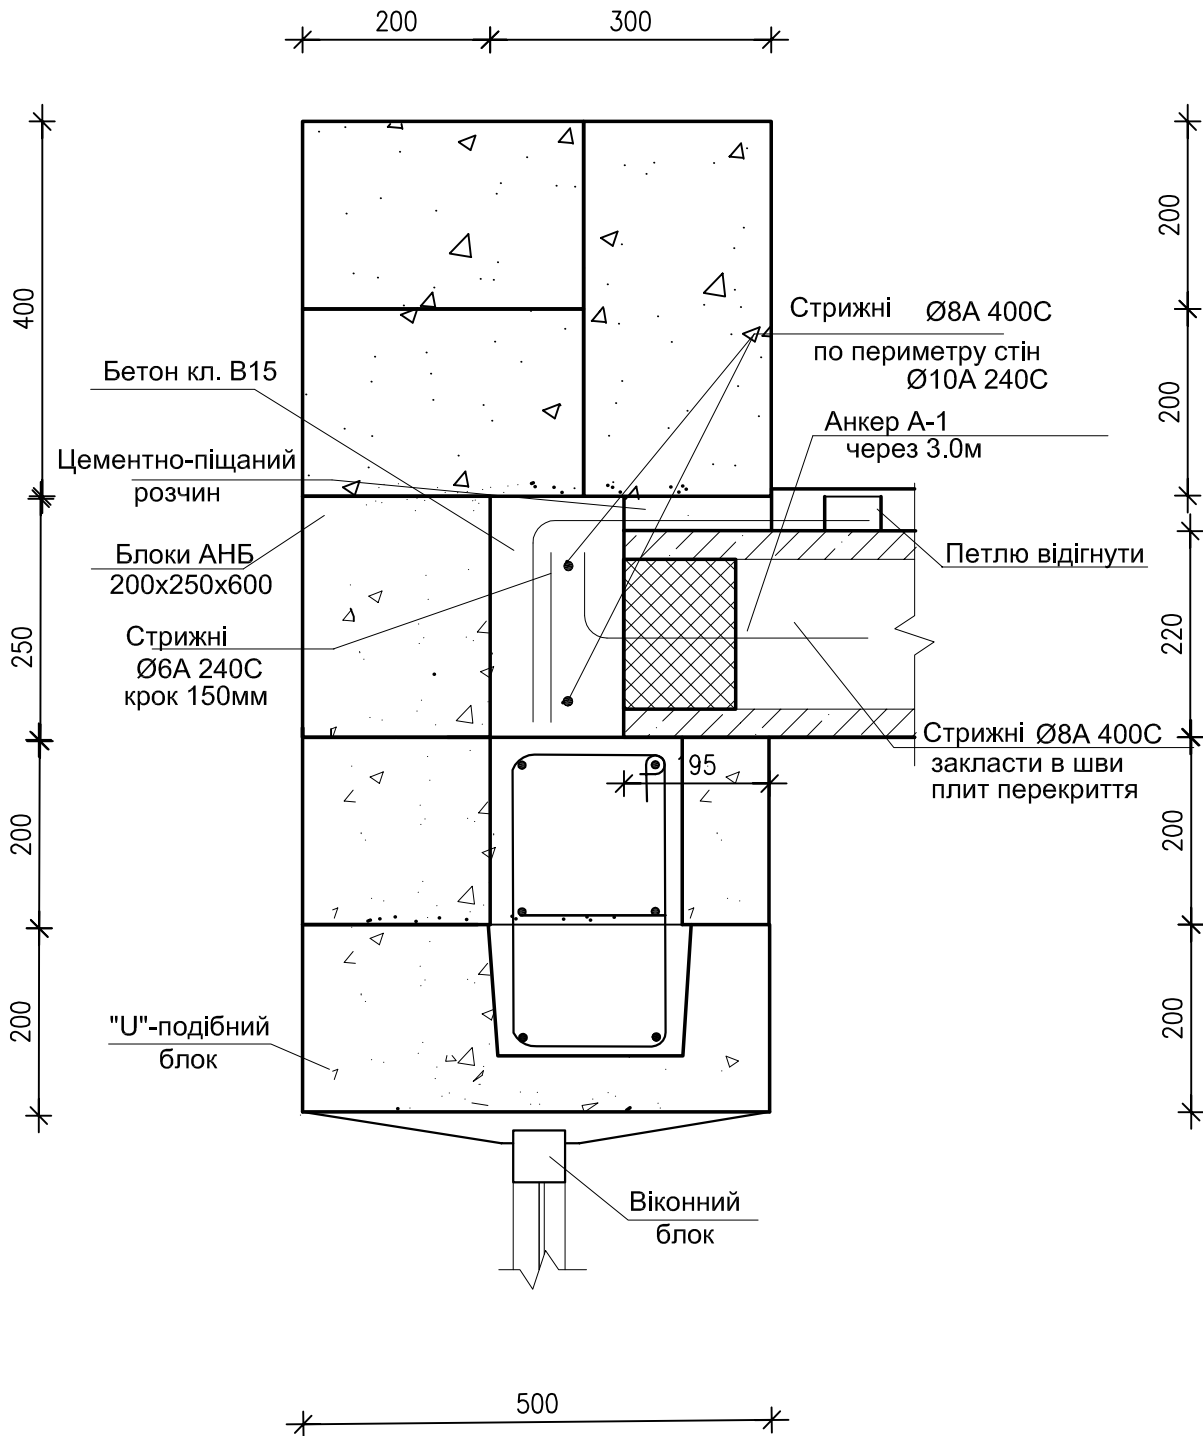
Двошарова стіна третього типу. Вузол спирання плити.
